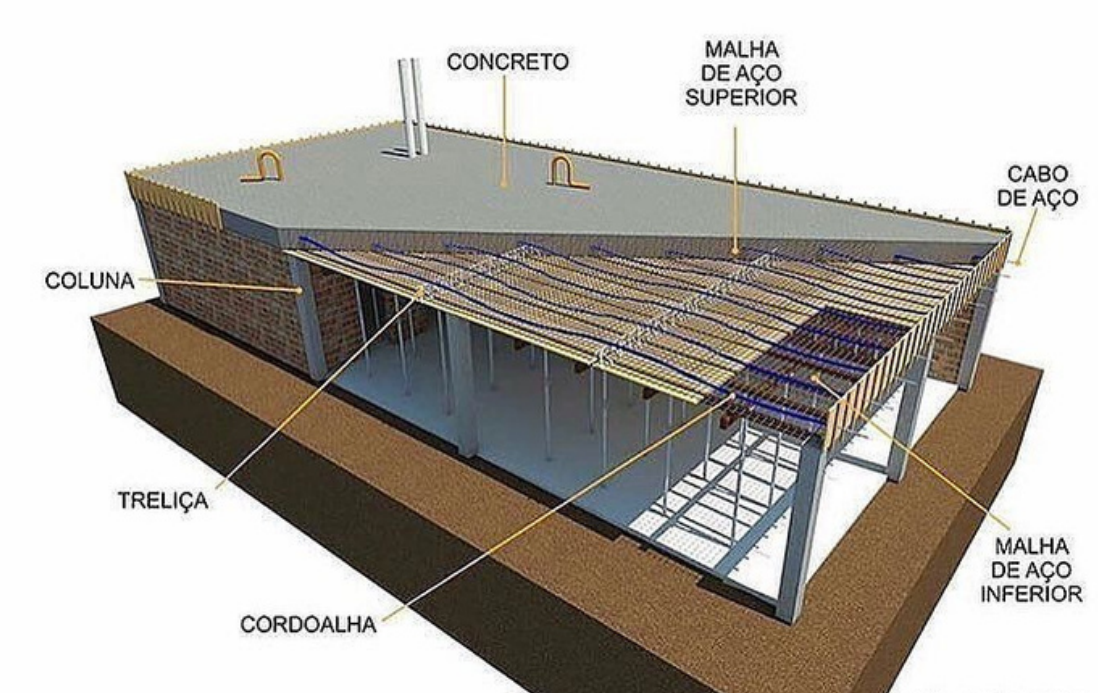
FIGURA EXEMPLO: Detalhes de uma laje Protendida. FONTE:br.pinterest.com
